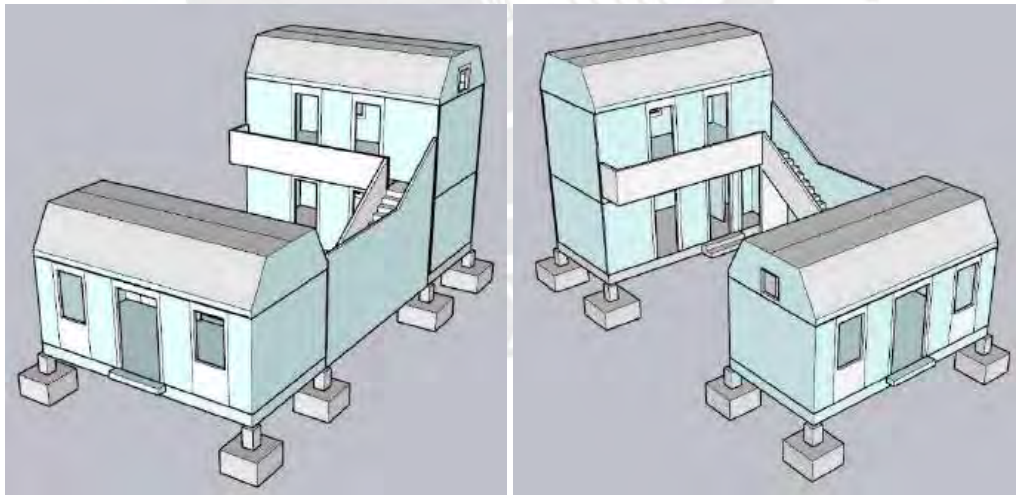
Modelado 3D - Casa Buena Vista - Upcrete
